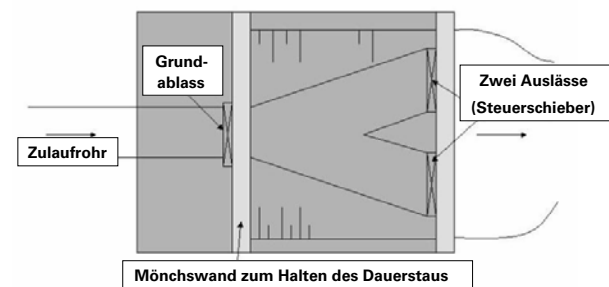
Grundriss eines Mönchsbauprodukts, links Schiebergestänge, rechts zwei Betriebsauslässe.
